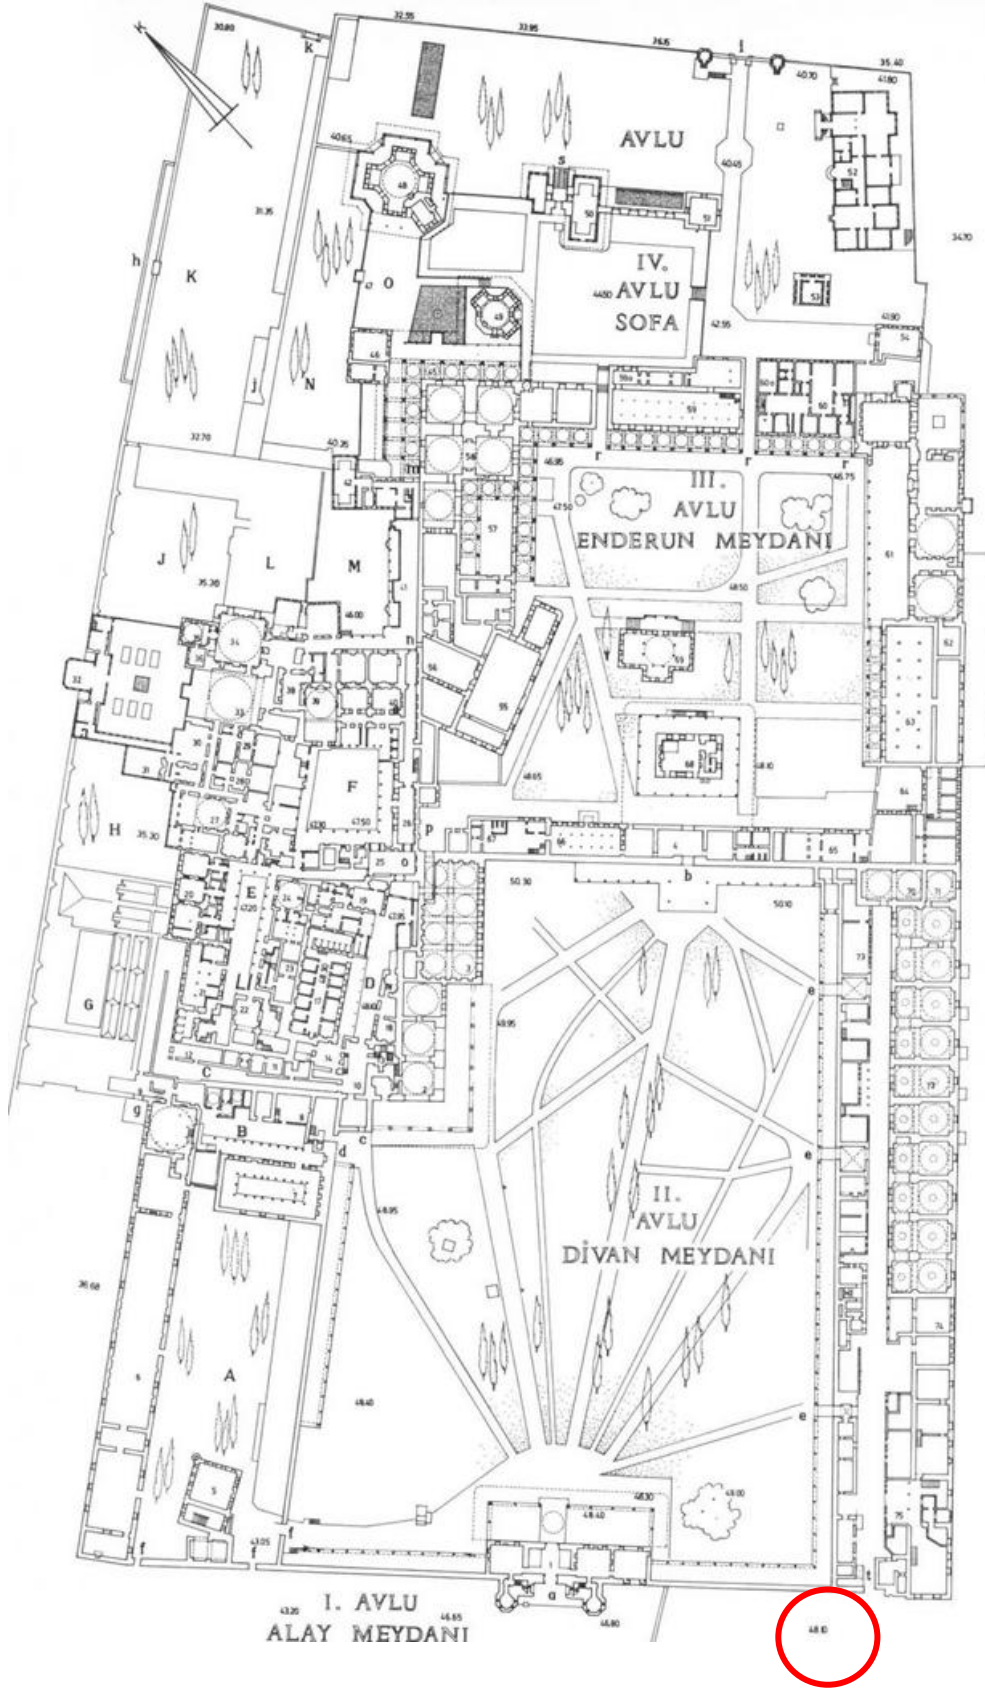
XVIII. Yüzyılın ilk yarısına kadar Topkapı Sarayı vaziyet planı, zemin kat (Eldem & Akozan, 1982)
